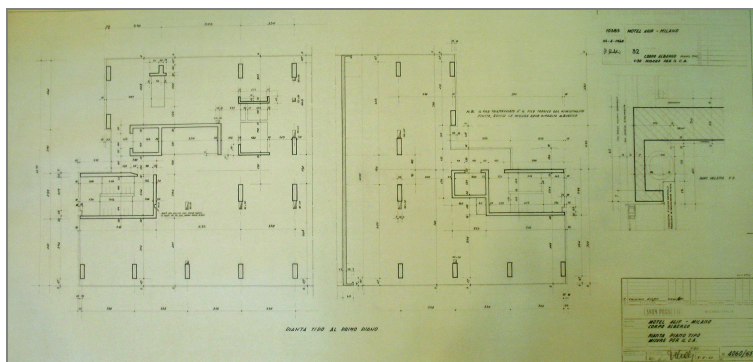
pianta piano tipo – misure per il c.a. (fonte CSAC – tav. 32, archivio n. 181-2)
